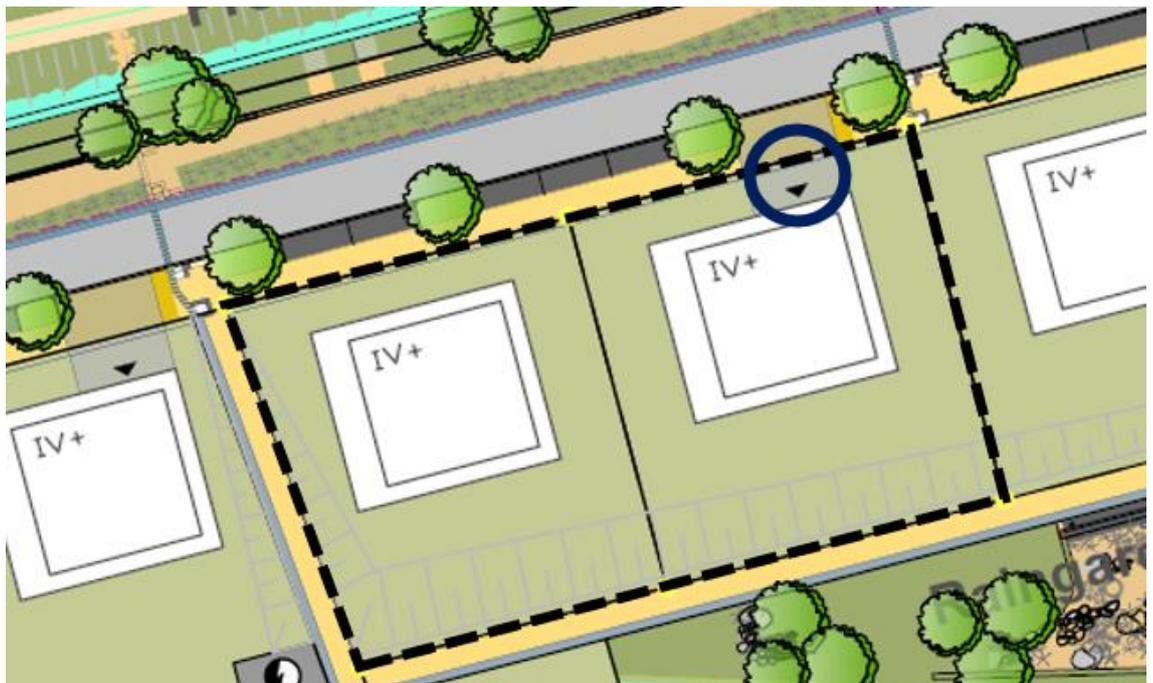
Lage der Tiefgaragenzufahrt im städtebaulichen Entwurf (Quelle: Stadt Bochum, eigene Bearbeitung)
